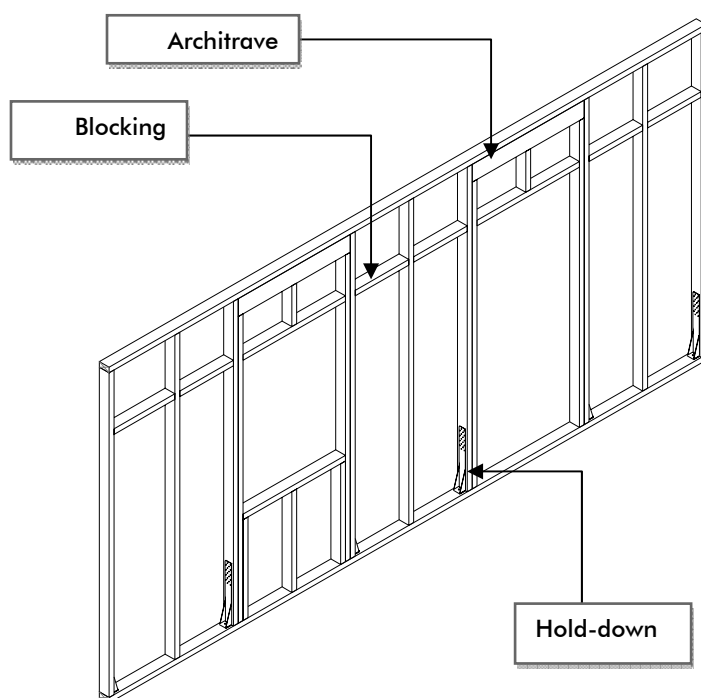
Dettaglio del telaio della parete con aperture per porte e finestre.
